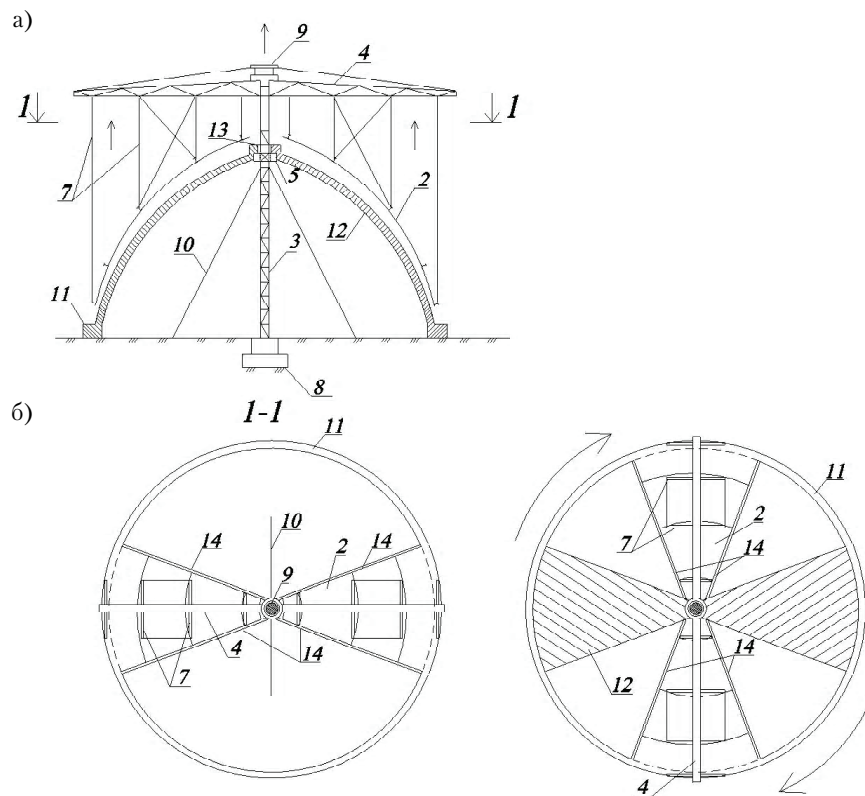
Раскружаливание опалубки купола: а) отрыв палубы от оболочки купола; б) поворот палубы на 90°; 2 – опалубка купола; 3 – временная опора; 4 – консольная стрела; 5 – неподвижное кольцо; 7 – связи; 8 – фундамент временной опоры; 9 – гидродомкрат; 10 – растяжки; 11 – нижнее опорное кольцо; 12 – оболочка купола; 13 – верхнее опорное кольцо; 14 – ограничительные бортики.
